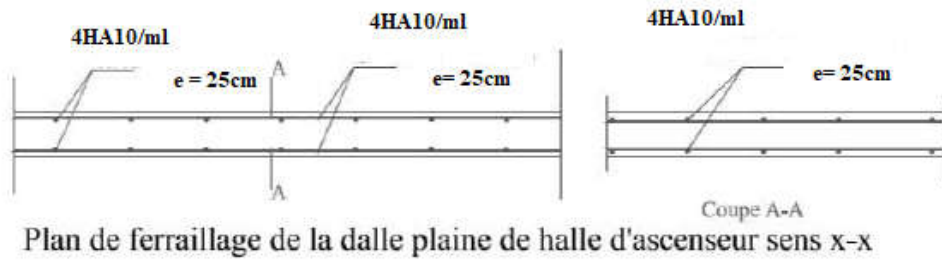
FERRAILAGE DE DALLE PLEINE DU HALL D'ASCENSUR.
